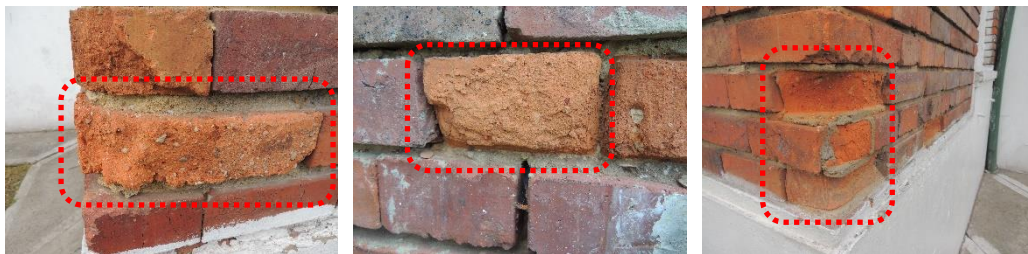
Detalle del material granular y delaminación de las piezas de mampostería.
